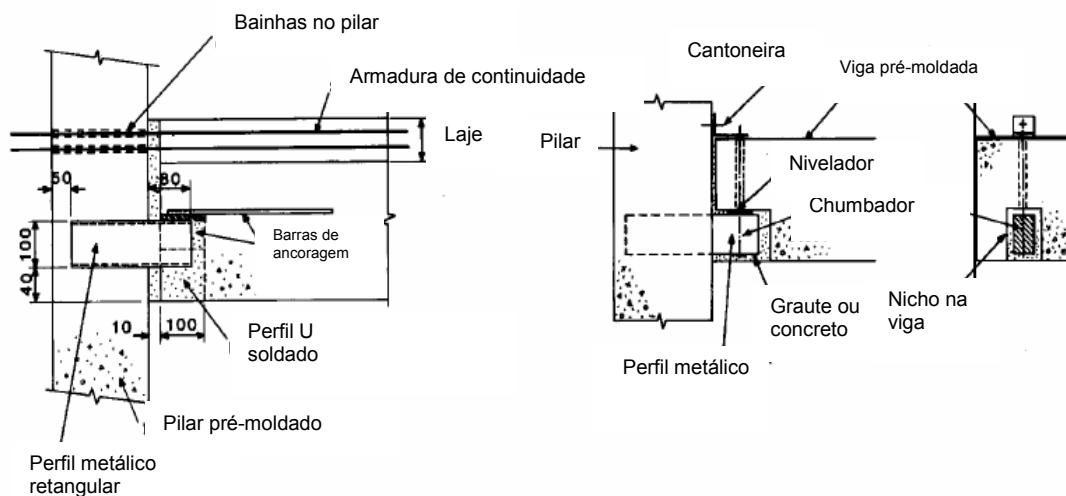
Ligação viga-pilar ensaiada por MIOTTO (2002).
